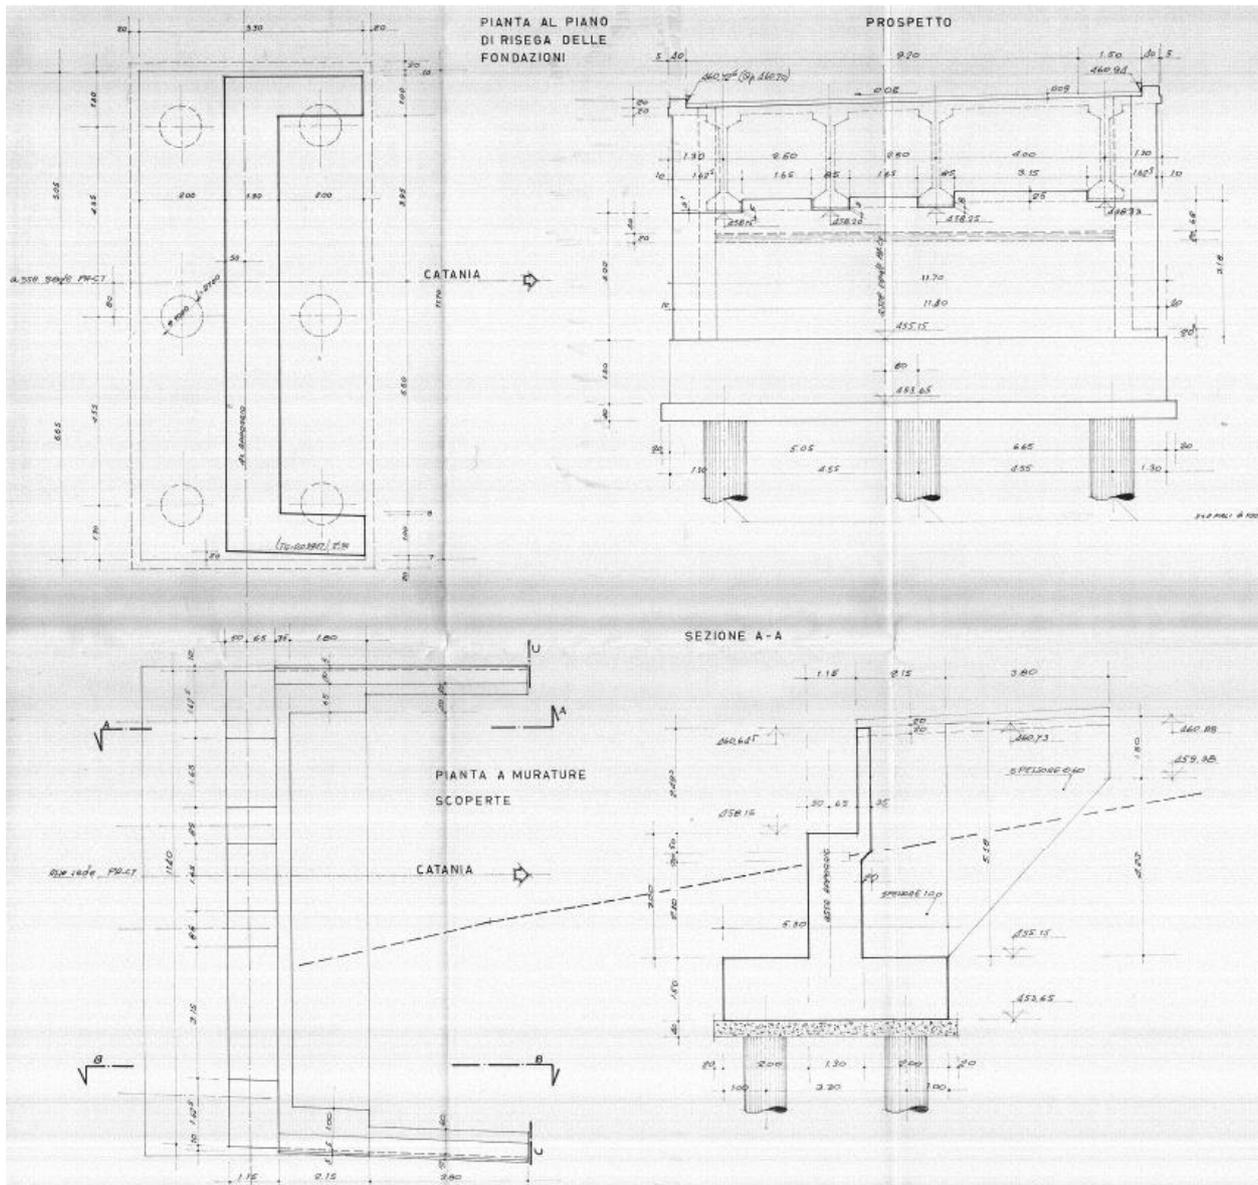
Impalcato a 4 travi in CAP – Spalla lato Catania – Carpenteria
